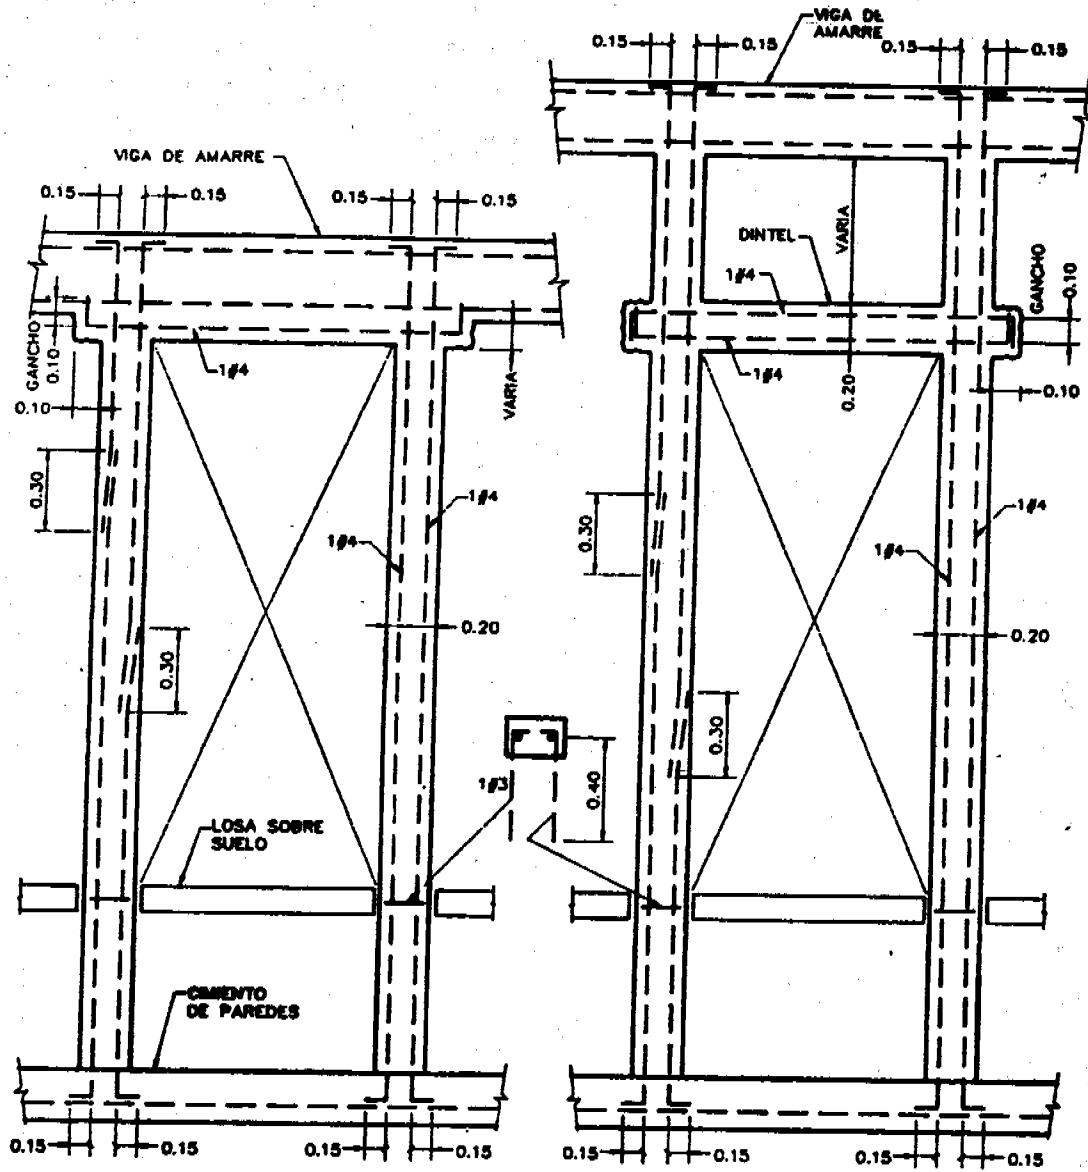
REFUERZO ALREDEDOR DE PUERTAS
